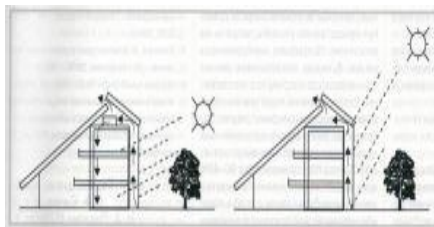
Разрез здания для солнечного отопления через двойной фасад
